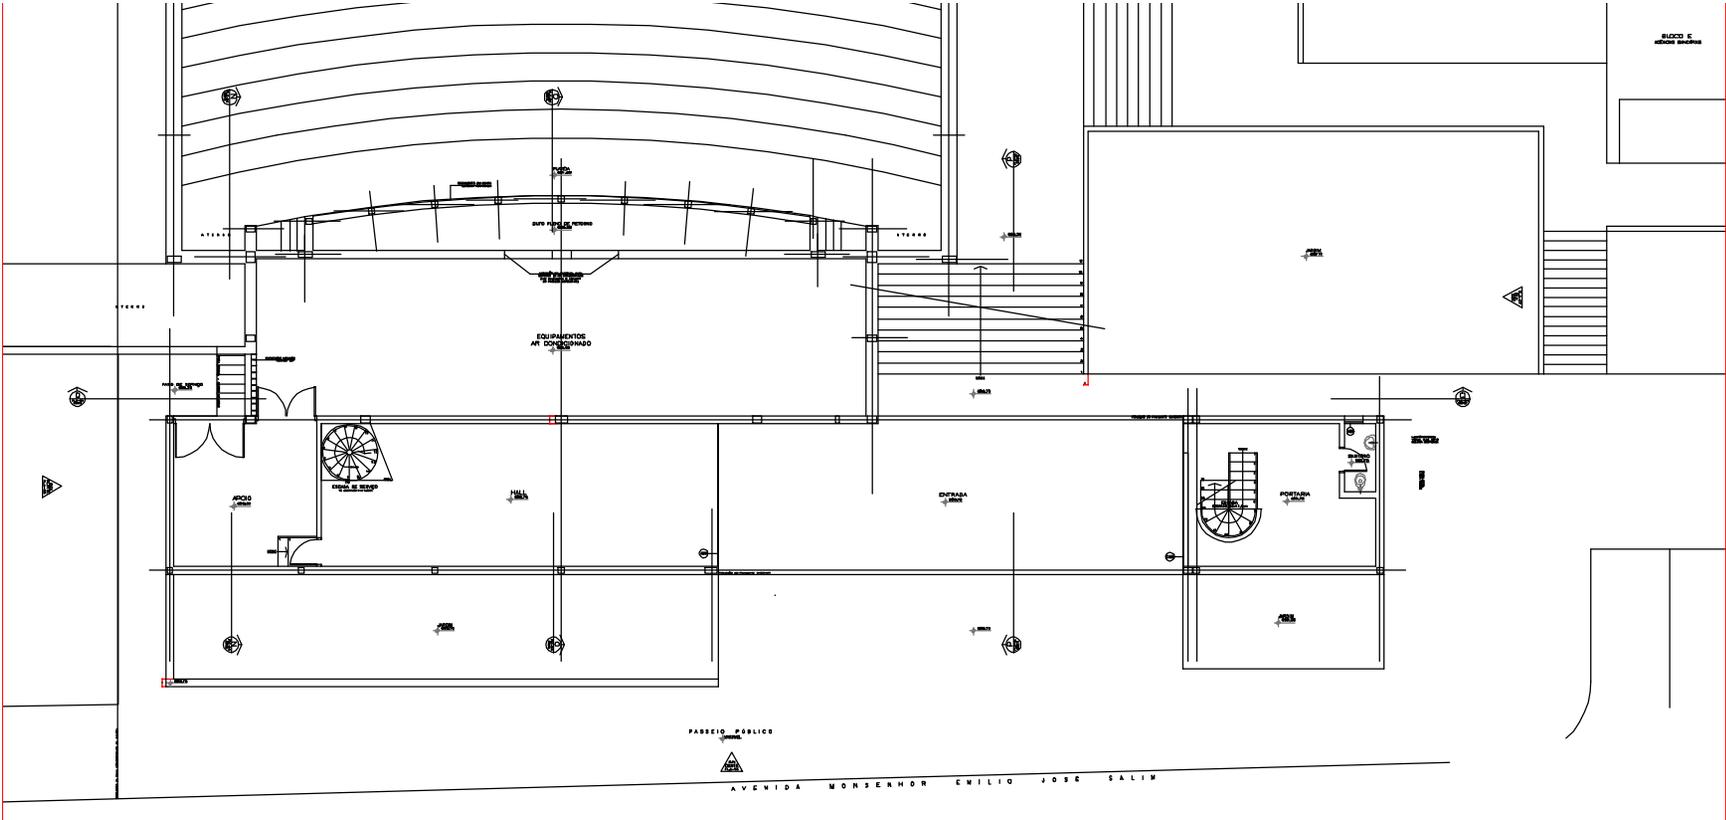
Planta Pavimento Subsolo – Auditório Dom Gilberto – Esc. 1/200
